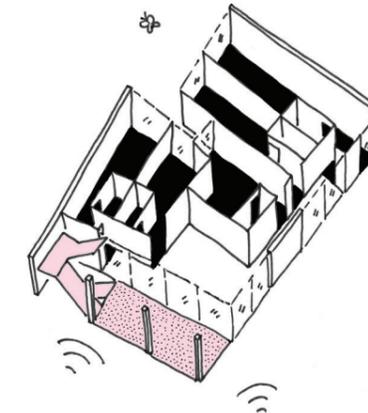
Gelegenheitsstrukturen auf Gebäudeebene, z. B. Überlagerung von Erschließung und Aufenthaltsflächen
